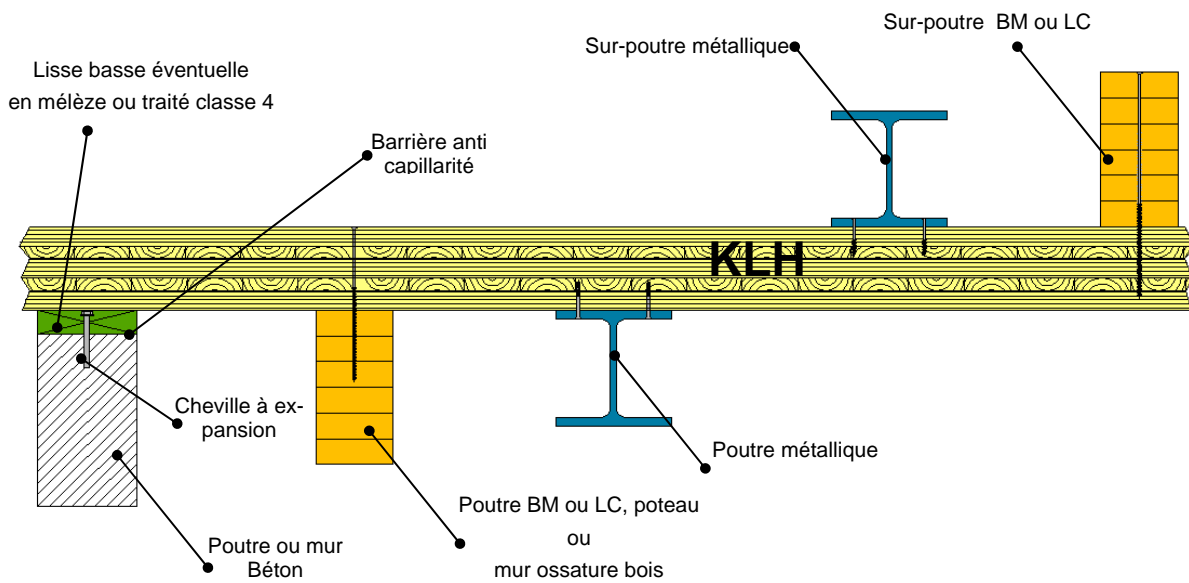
Autre Type d'appui usuels sur plancher KLH
